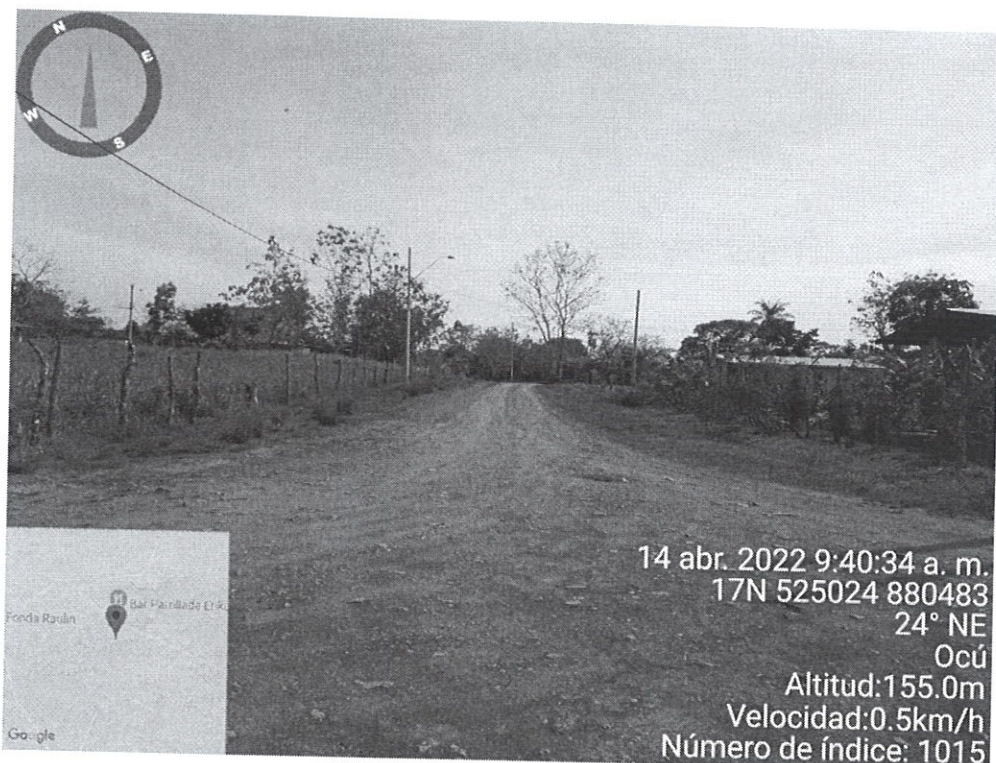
Vista de la topografía del proyecto, se observa la parcelación de lotes y la construcción de las calles.
